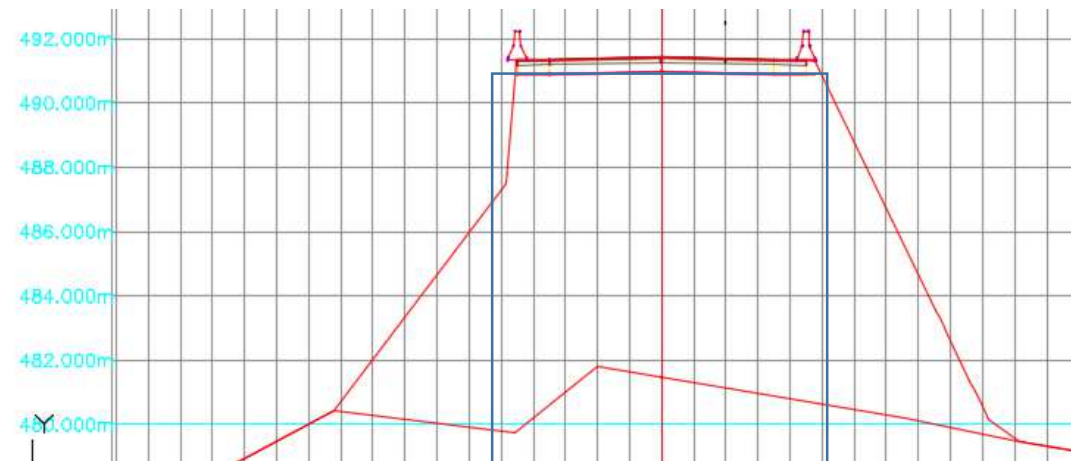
Cálculo de la distancia de soterramiento, estribo 1
